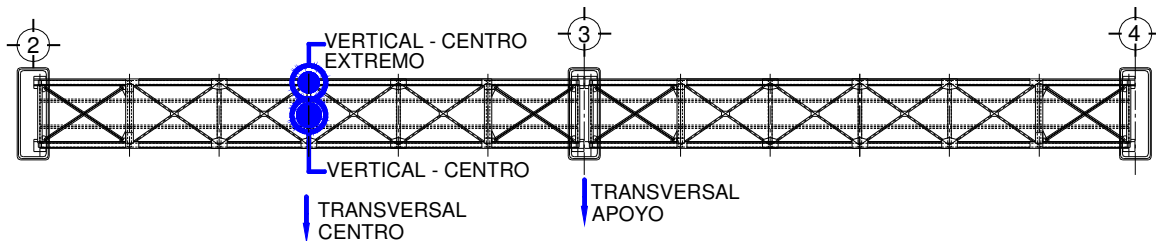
Posición de sensores en planta sobre el puente La Lana. Claro 2-3
